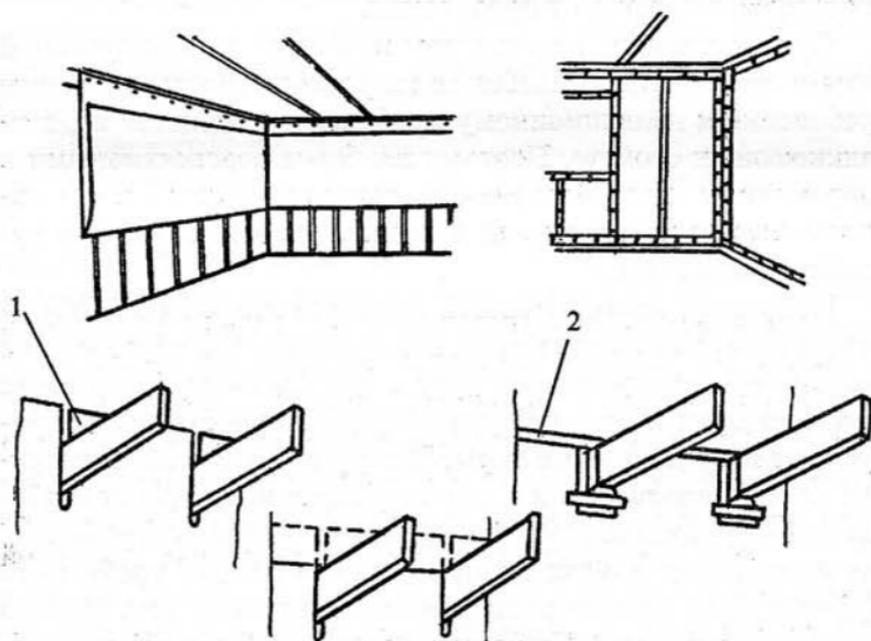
Принцип установки пароизоляционного слоя на внутренней стороне наружных стен и способ уплотнения проходов балок перекрытия:
